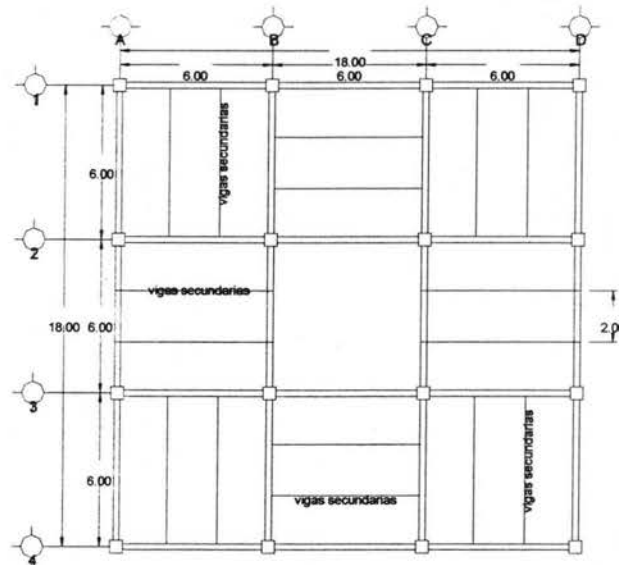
Planta Tipo del Edificio, Caso 1
